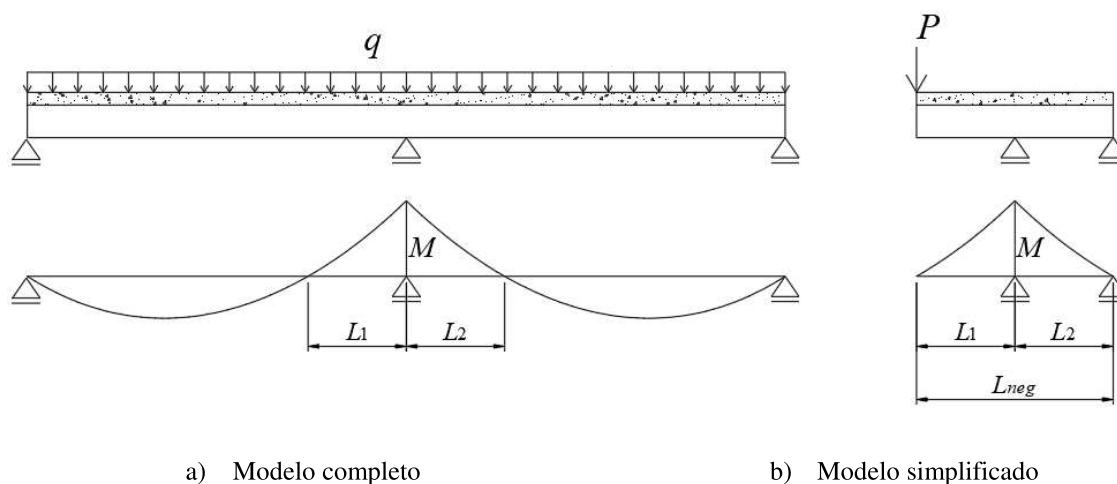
Carregamento aplicado no modelo simplificado.
